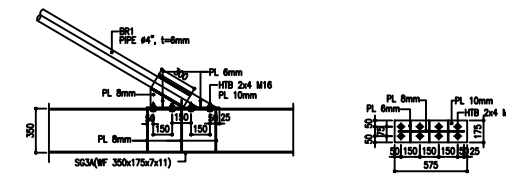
DETAIL SAMBUNGAN SB1 KE BALOK BAJA
